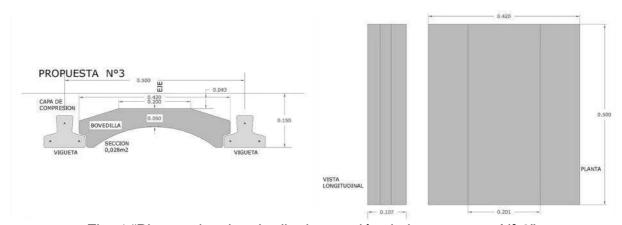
"Planta, vista longitudinal y sección de la propuesta Nº 3"
